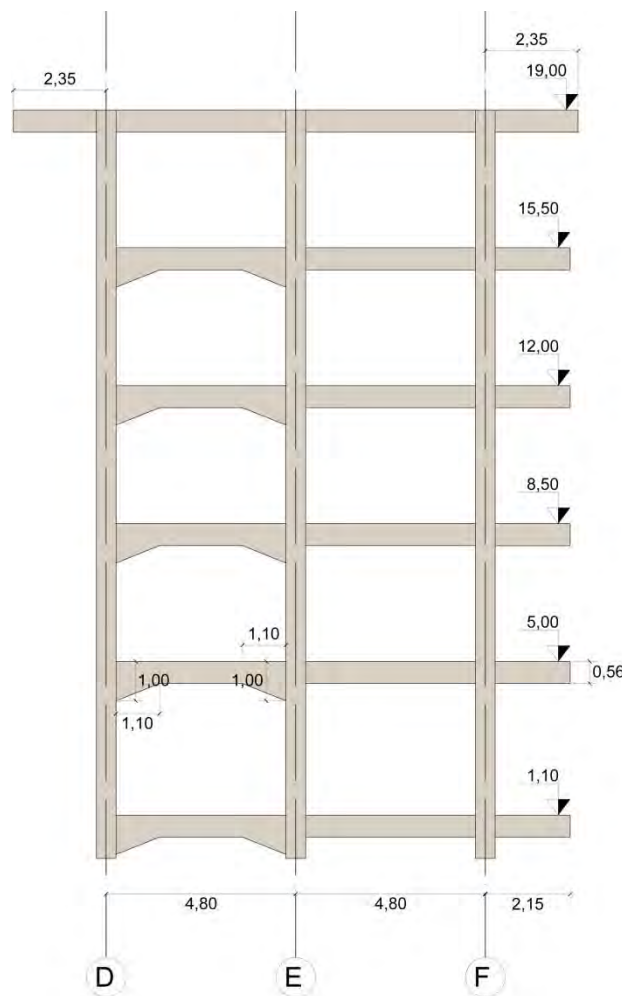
Telaio tipo corpo Est con riportati gli assi dei pilastri.
